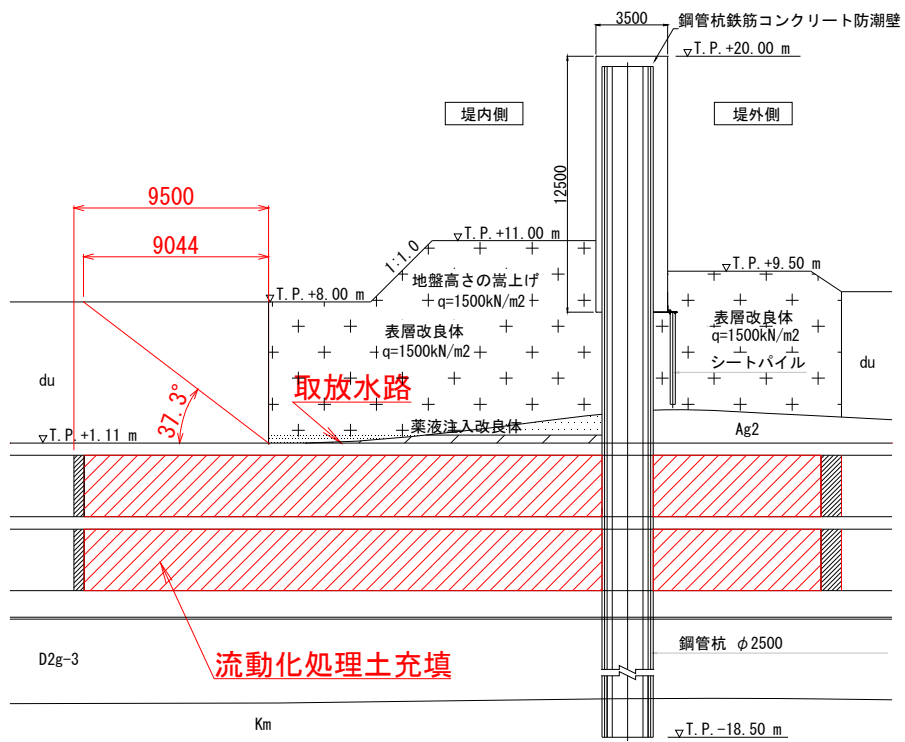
取放水路埋戻し位置断面図 (B-B断面)
